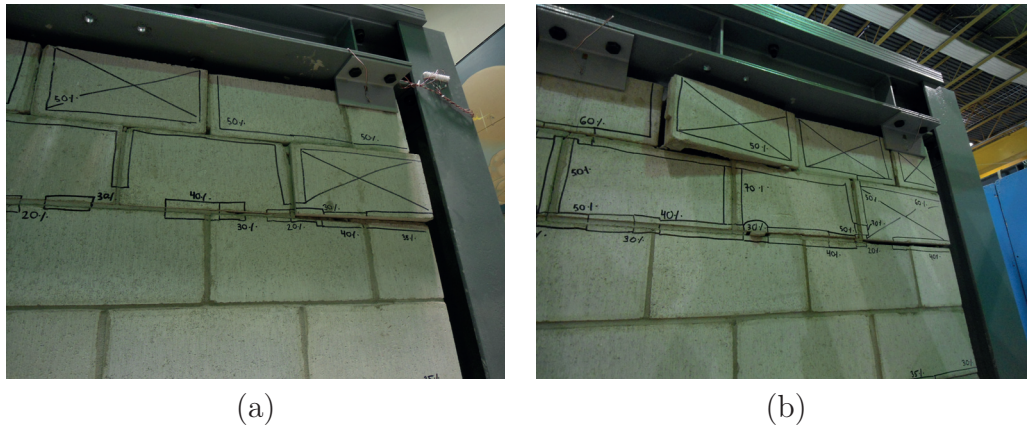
Photos de l'endommagement du mur 2 après l'essai MAL12-0.70 (a) façade arrière du mur à l'extrémité droite (b) façade avant du mur à l'extrémité droite
